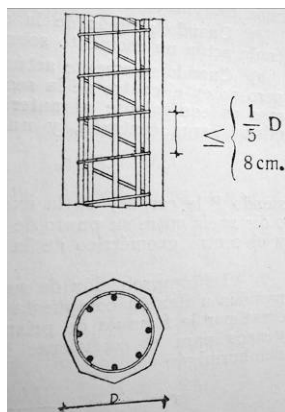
Pilar zunchado. Norma de 1941. (DGA, 1941)
